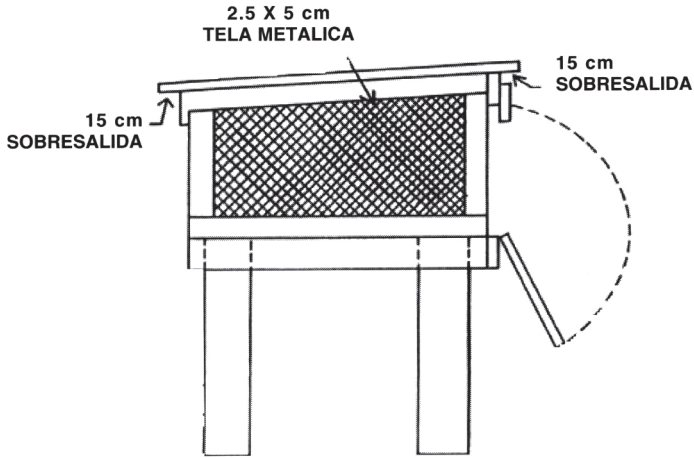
Jaula de estructura de madera con lados de tela metálica y techo sobresaliente.
